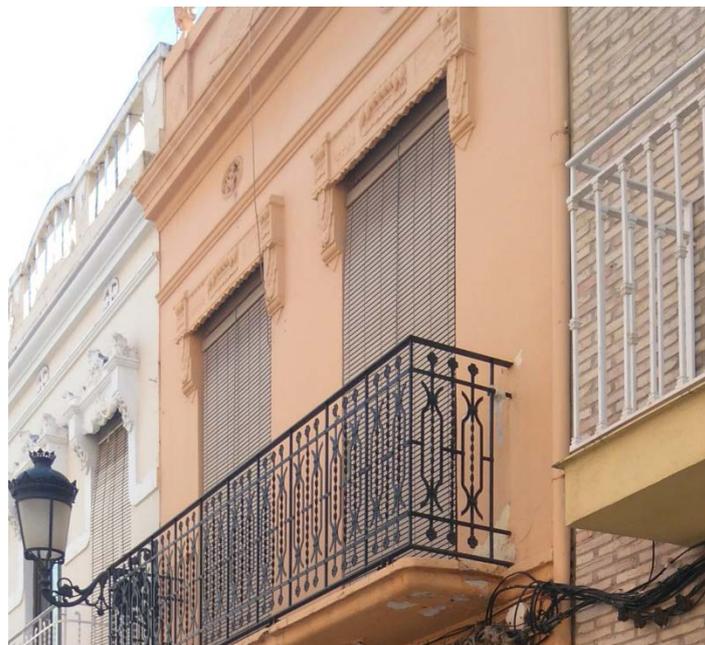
Fotografía humedad filtración en balcón Primera Planta. Fuente propia
